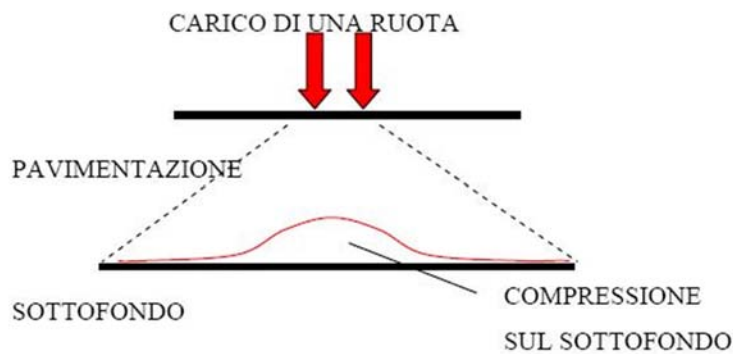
Effetti sul sottofondo di una pavimentazione con alto modulo di rigidità
